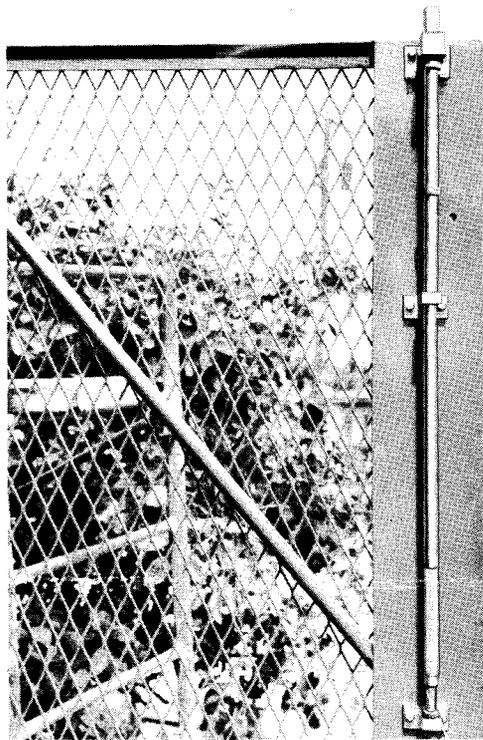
Vista de otro portón o barrera de apeadero con cerrojo. Este cerrojo sirve como pestillo y mango conveniente para abrir o cerrar la barrera o portón. Cada barrera o puerta del pozo estará equipada con un inmovilizador eléctrico.
